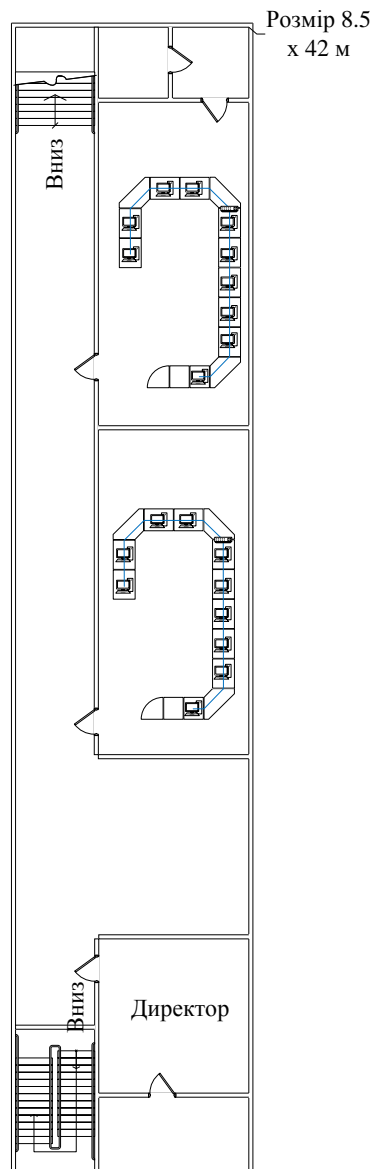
Схема лівого двоповерхового корпусу
